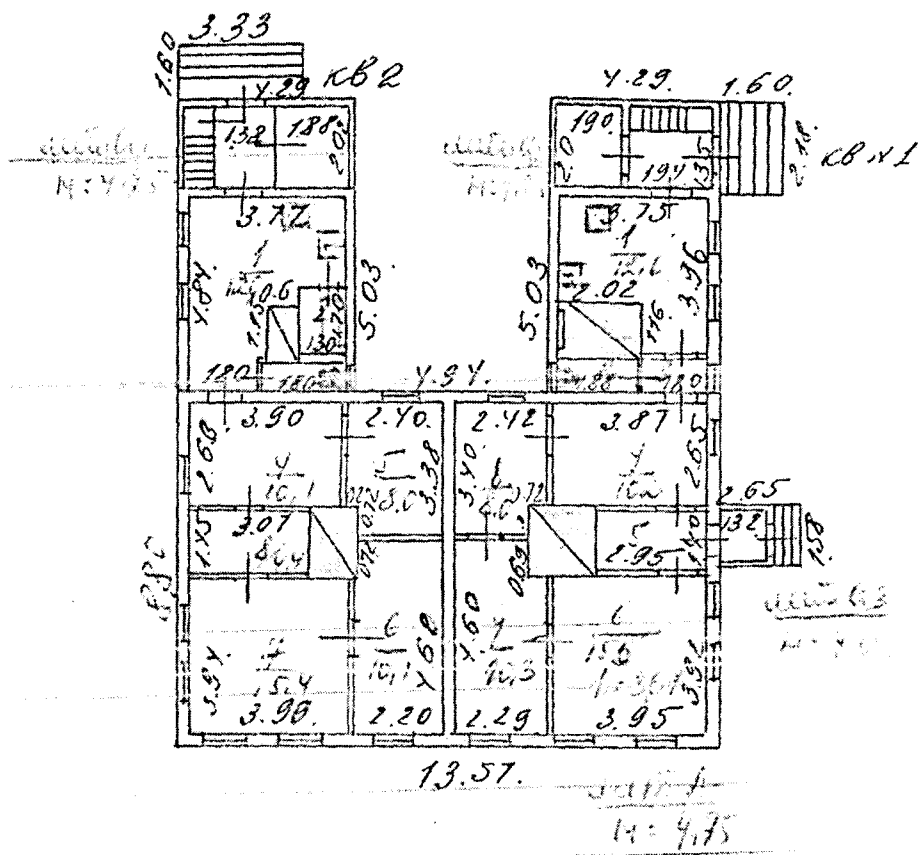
поэтажные планы жилого дома лит. А. Архив 1980 г.
